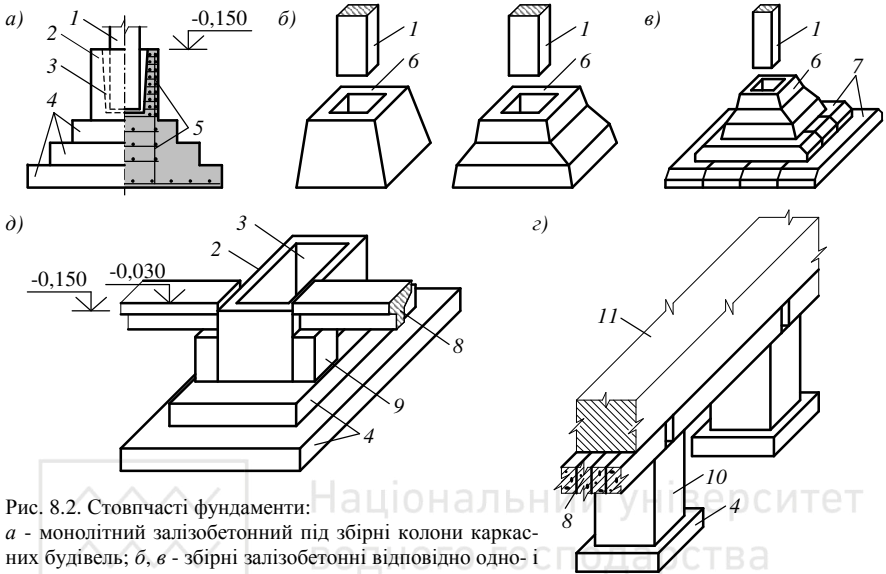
Ступчасті фундаменти: а - монолітний залізобетонний під збірні колони каркасних будівель; б, в - збірні залізобетонні відповідно одно- і багатоблокові під збірні колони каркасних будівель; з - обпирання фундаментних балок на ступчастий фундамент під колону; д - монолітний під стіни безкаркасних будівель; 1 - збірна колона; 2 - монолітний підколонник; 3 - стакан для колони; 4 - монолітна плитна частина фундаменту (одно, дво- або трисхідцева); 5 - армування; 6 - збірний фундамент стаканного типу; 7 - збірні фундаментні плити-подушки; 8 - збірна фундаментна балка (рандбалка); 9 - бетонний стовпчик (монолітний або збірний); 10 - монолітний фундаментний стовп; 11 - цегляна кладка
